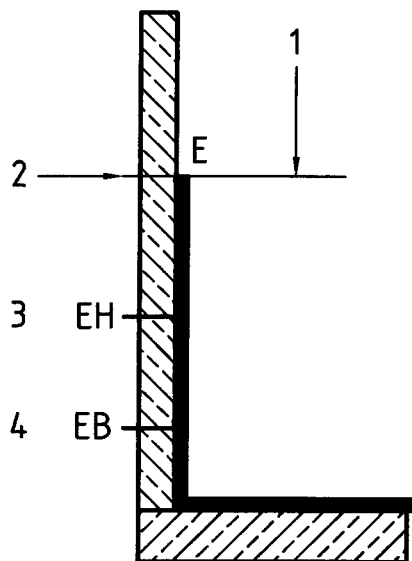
exemple de cas d'eaux de ruissellement ou d'infiltration avec drainage avec revêtement
